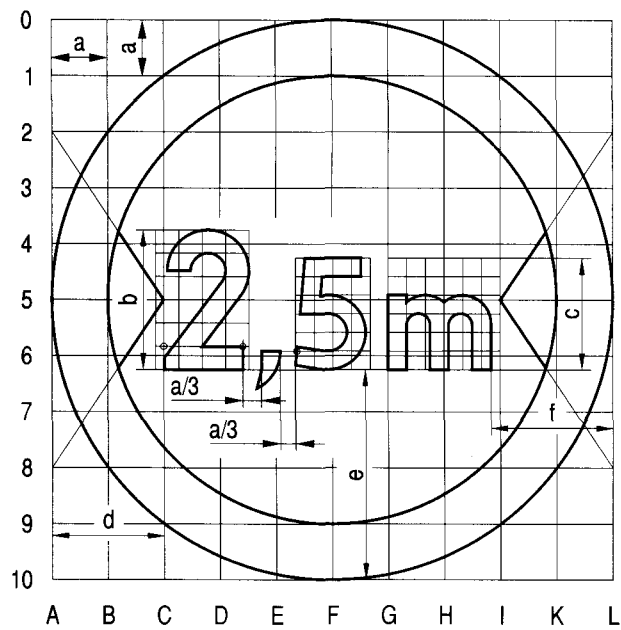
Konstrukcja znaku B-3/4/10
